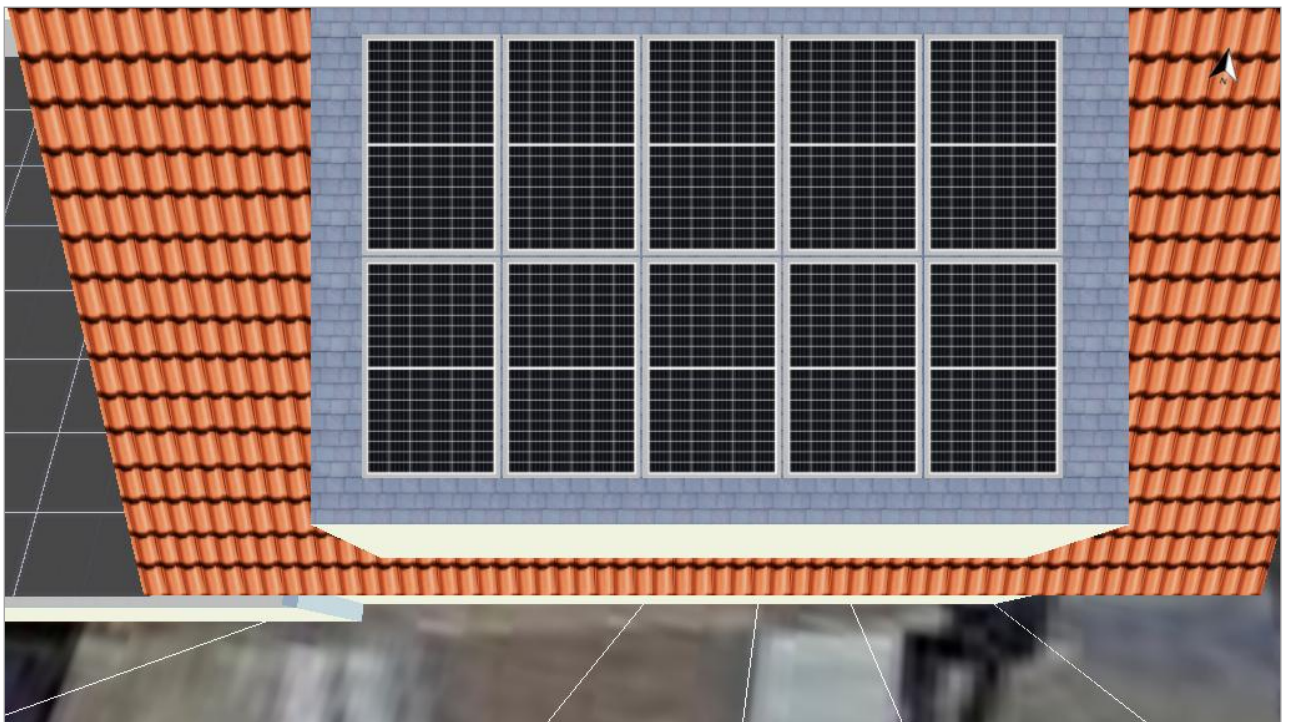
Modulfläche - Dachgaube 01-Dachfläche Süd
